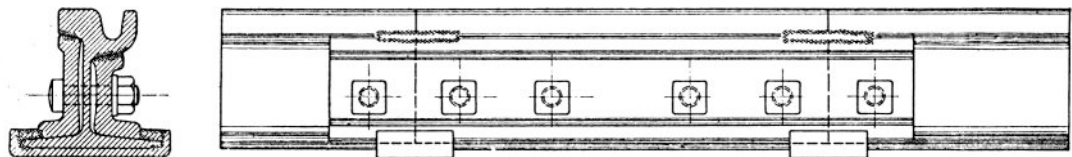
Fest verschweißte Schienenstoßverbindung (Laschenschweißung früherer Ausführung).
